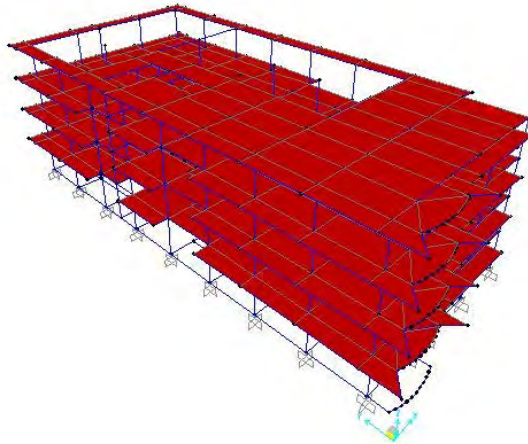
Denah Struktur Perkantoran KOMINFO JATIM
